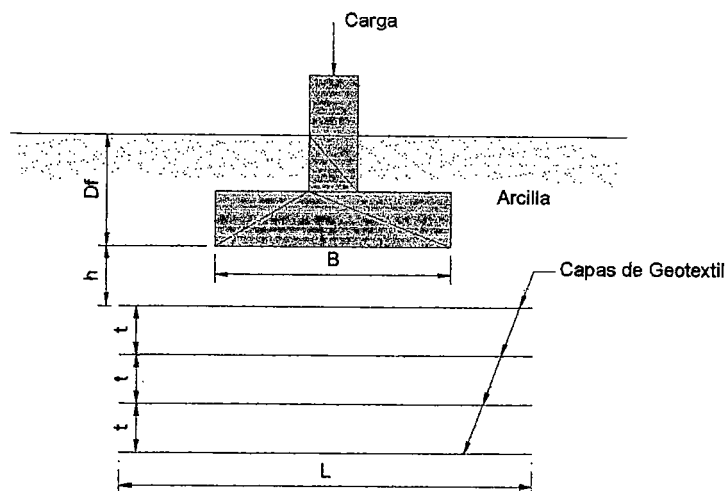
Cimentación Superficial sobre arcilla reforzada con geotextil
